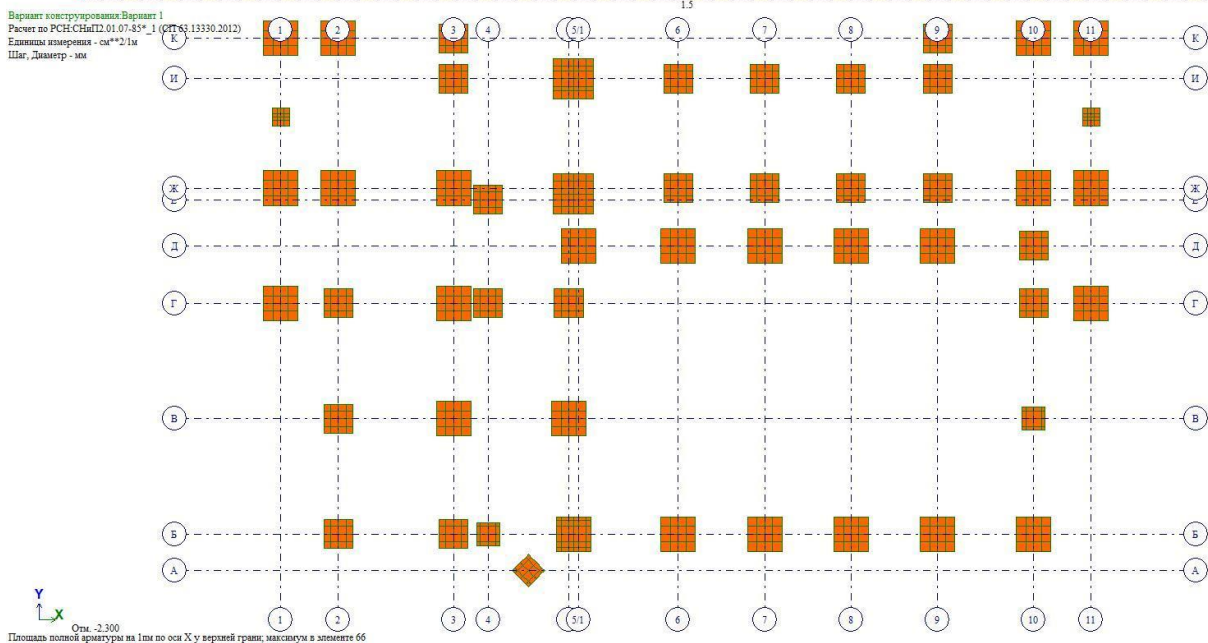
Фундаменты. Армирование по X верхняя
